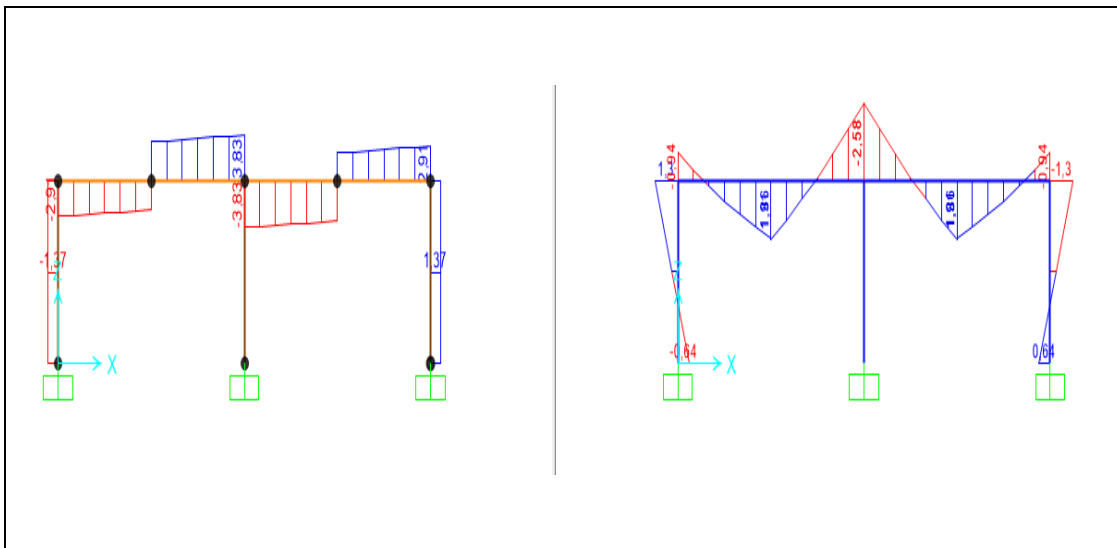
Momentos de los pilares y las vigas - vista lateral
